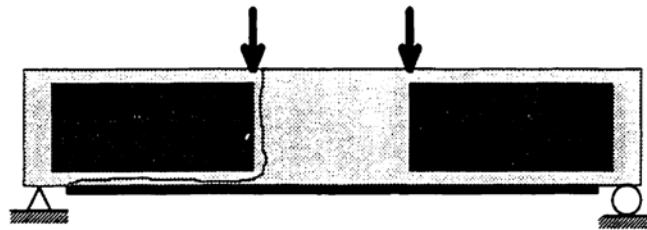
Collage de plaques sur les parois verticales de la poutre [dans 17].
